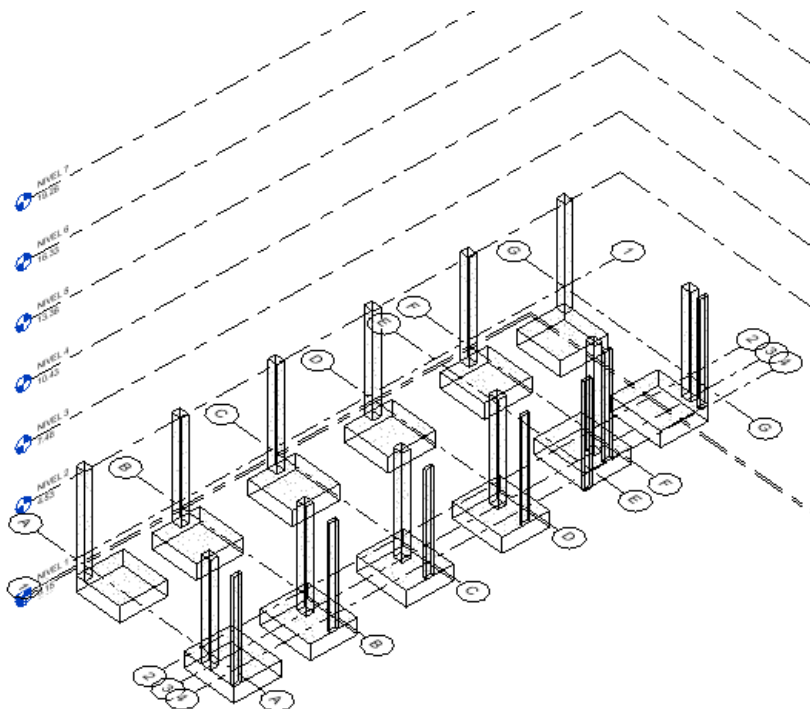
Vista 3D de Columnas modeladas (Fuente: Elaboración Propia).
